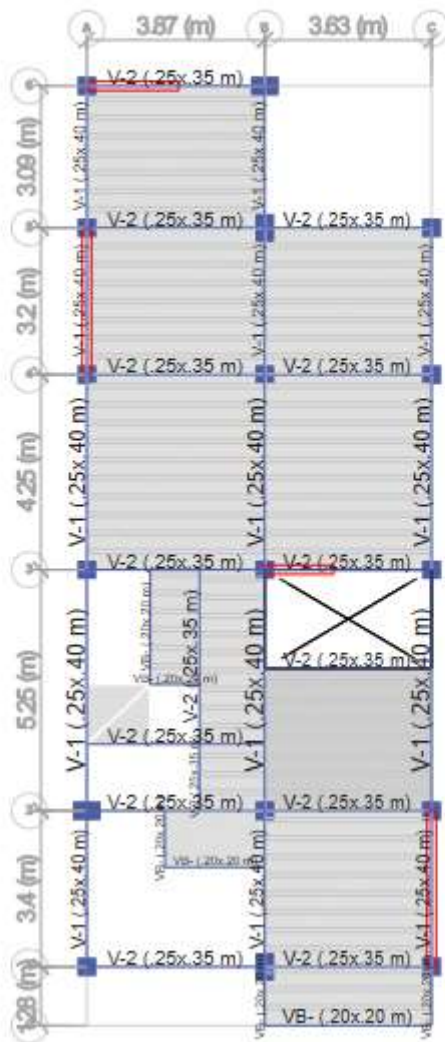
Vista en Planta con la Sección de la Edificación
